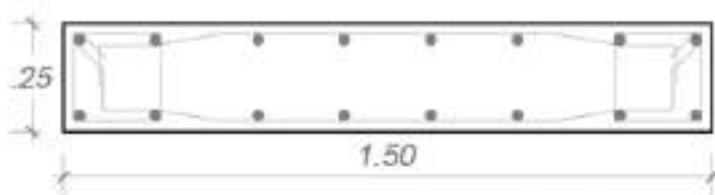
Disposición de acero de refuerzo inicial en la placa PL-1
